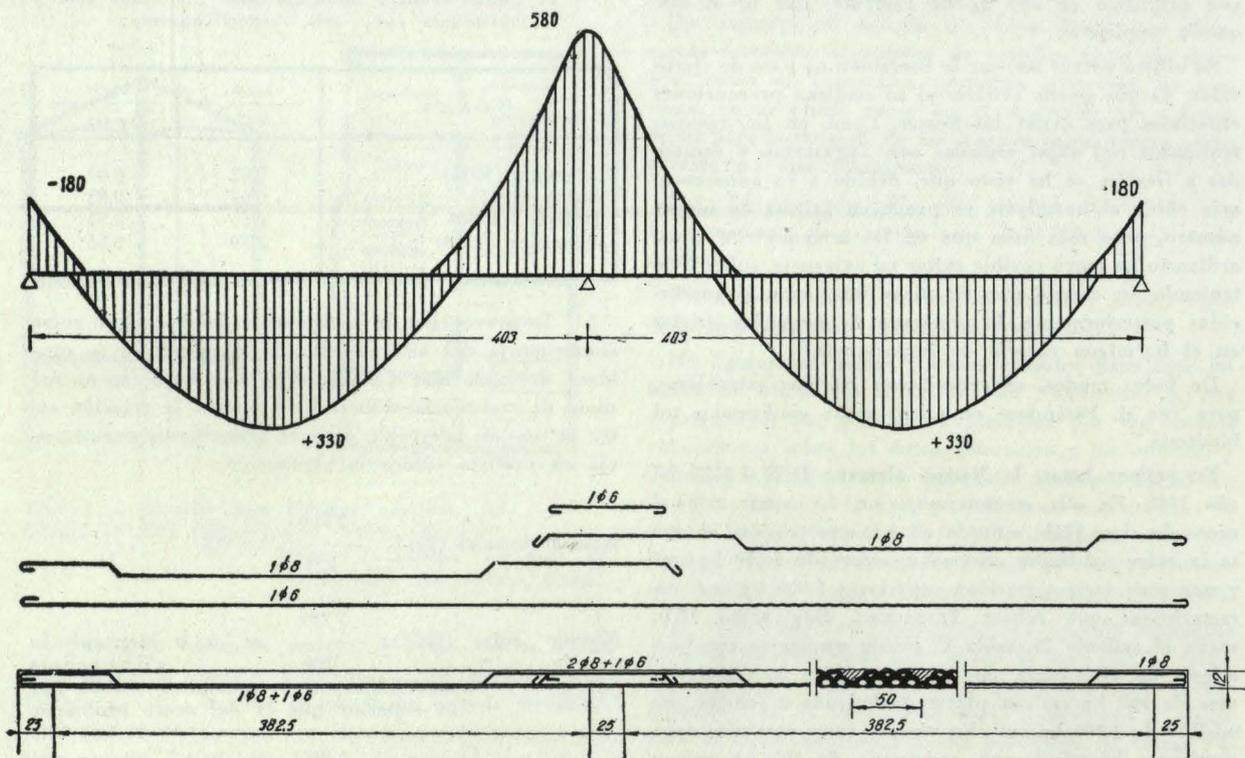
Forjado para las viviendas. Gráfica de momentos flectores, armado y sección.
